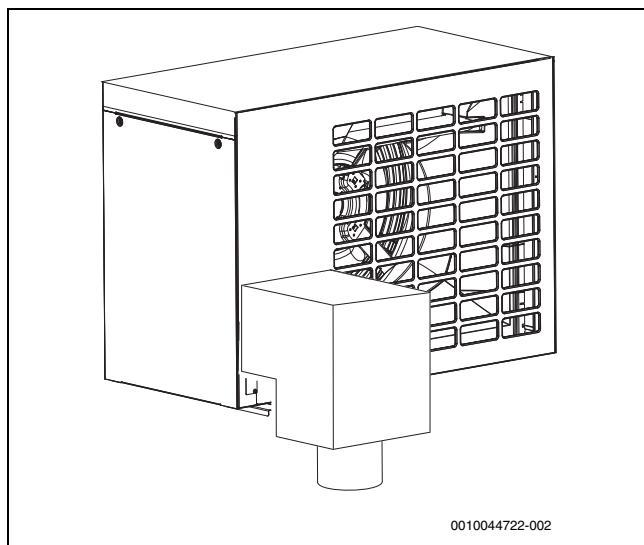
Installationspaket (INPA) mit Dämmschalen, bodenstehende Montage
